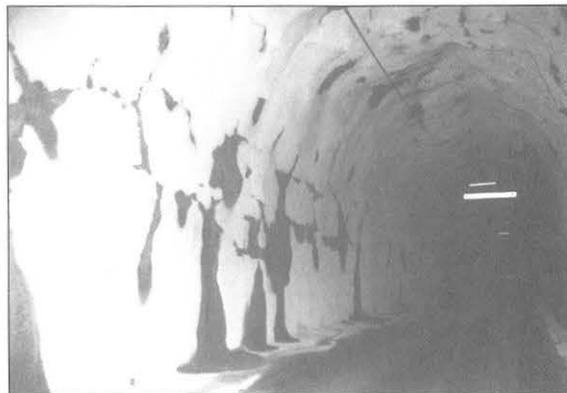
Gerissener einschaliger Ausbau mit Spritzbeton
